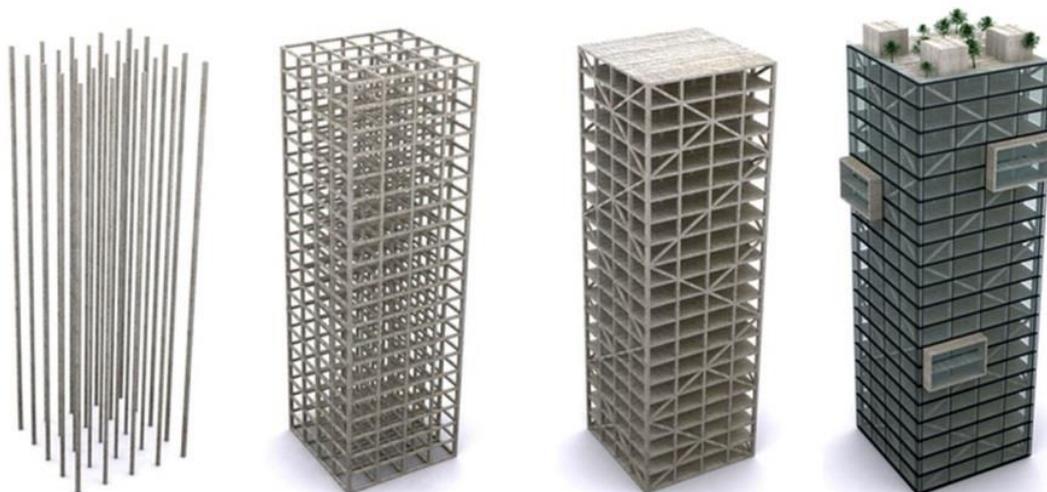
Sistema Construtivo Proposto com o Barents House ²⁰
